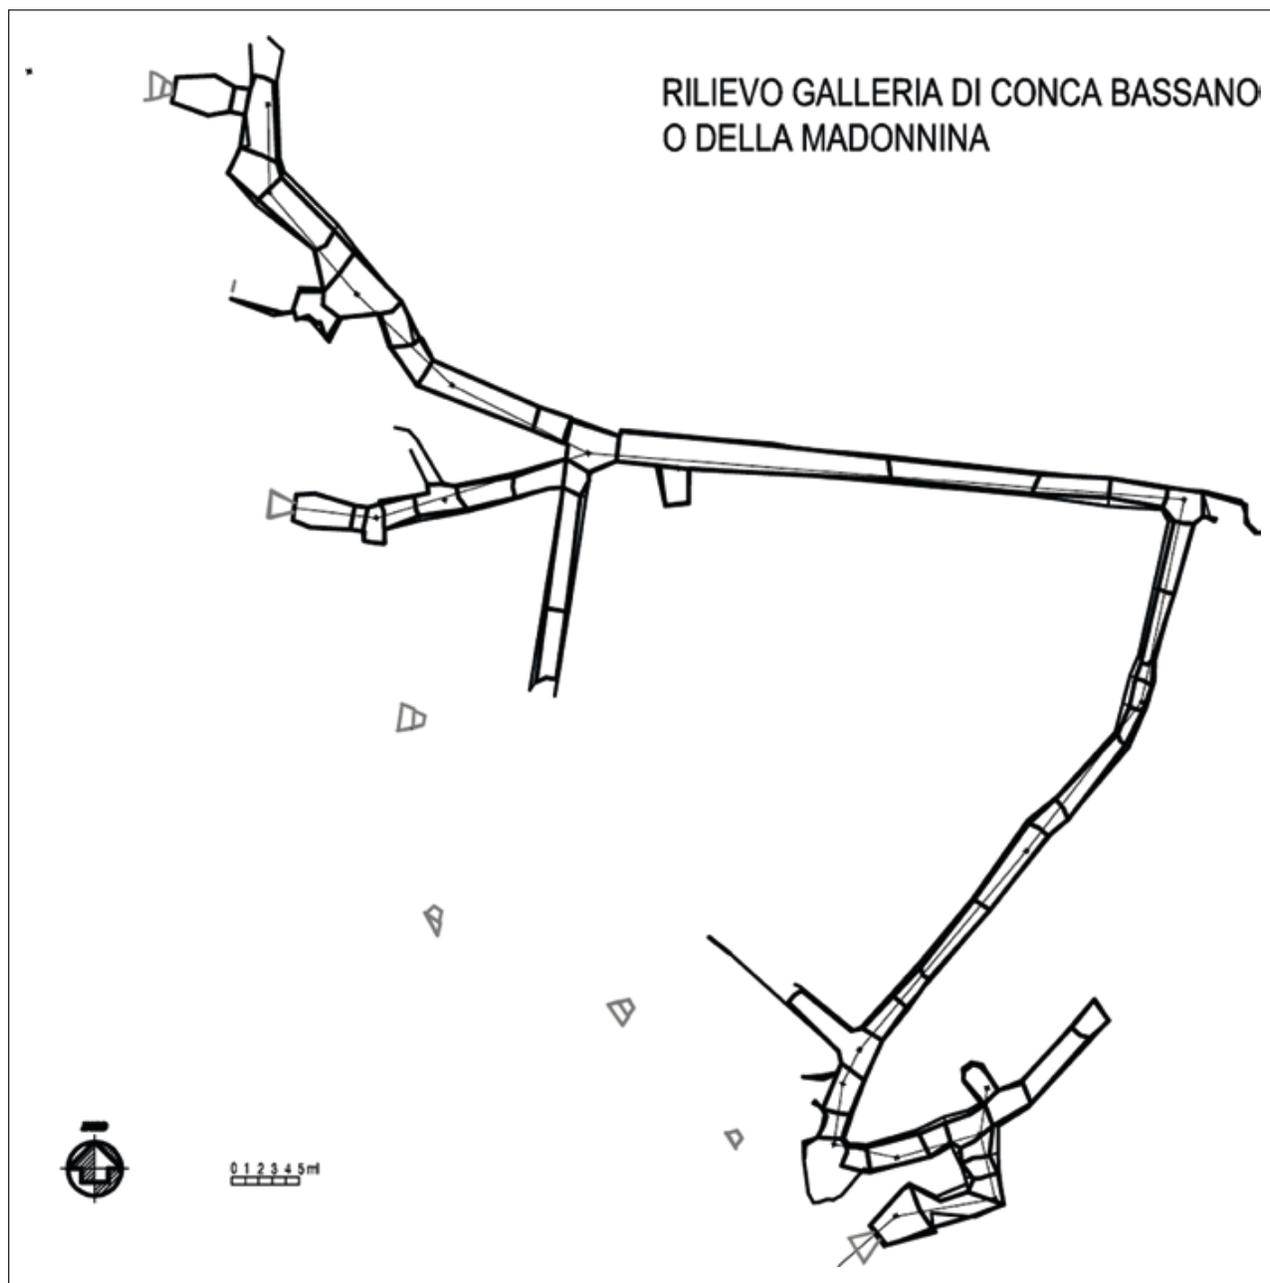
Planimetria generale della galleria (disegno C. Dal Bianco).
